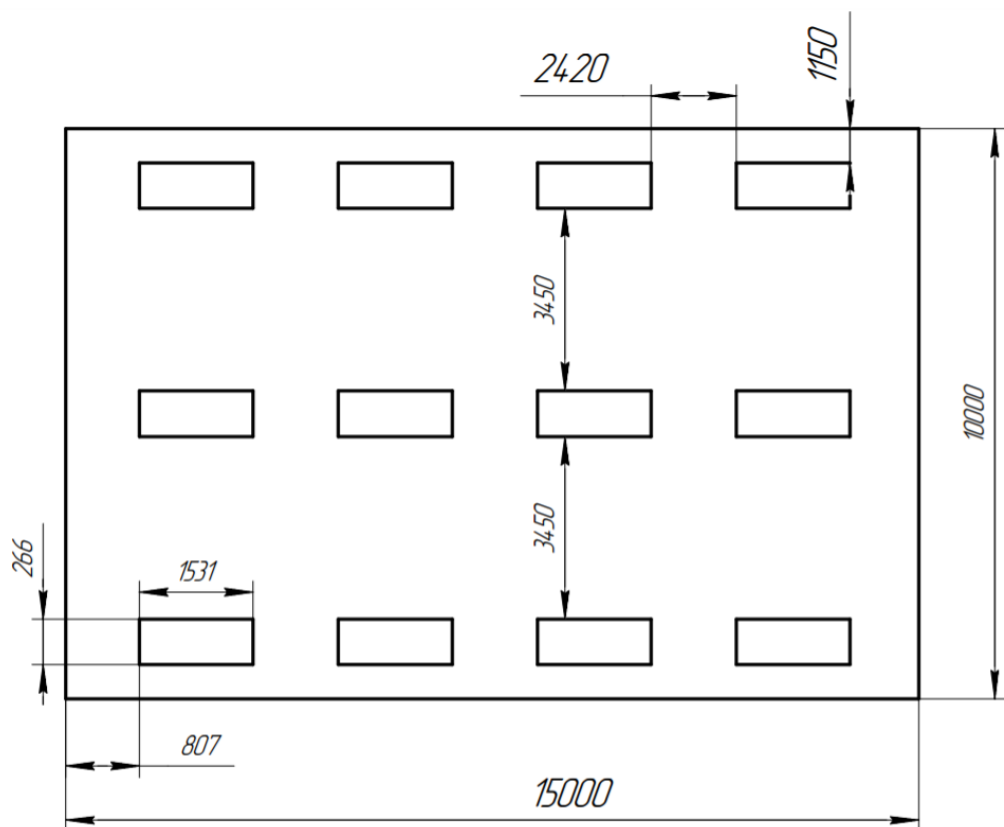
План помещения и размещения светильников с люминесцентными лампами
